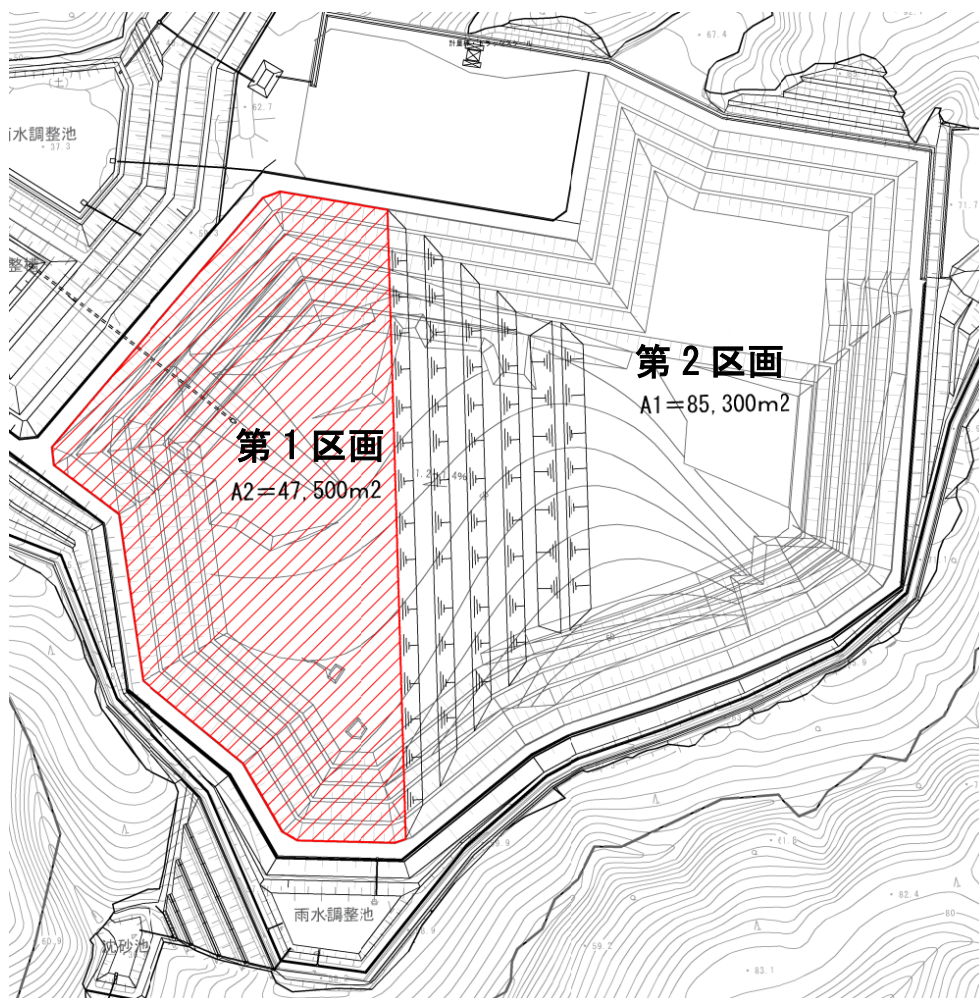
区画埋立による浸出水量削減対策（平面図）
